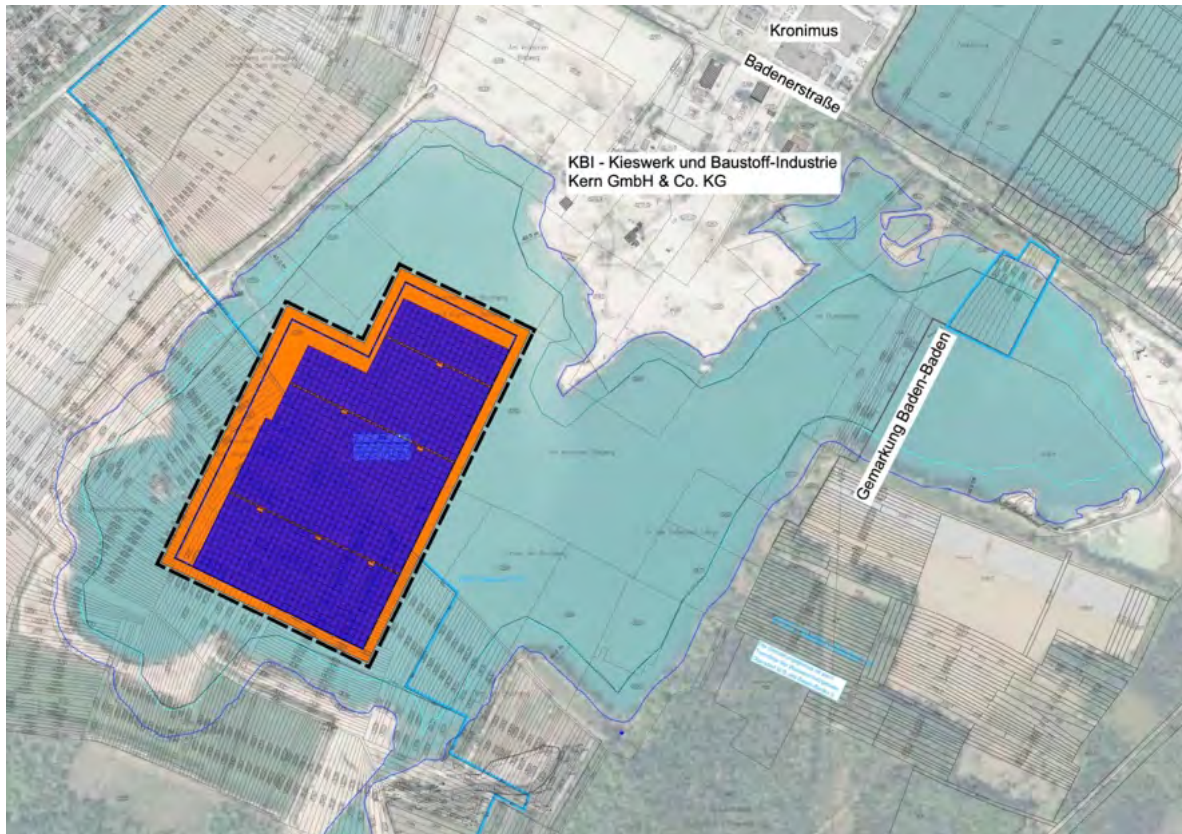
Darstellung der schwimmenden PV-Anlage auf dem Untersuchungsgewässer (Abbildungsgrundlage Arguplan 17.4.23)
